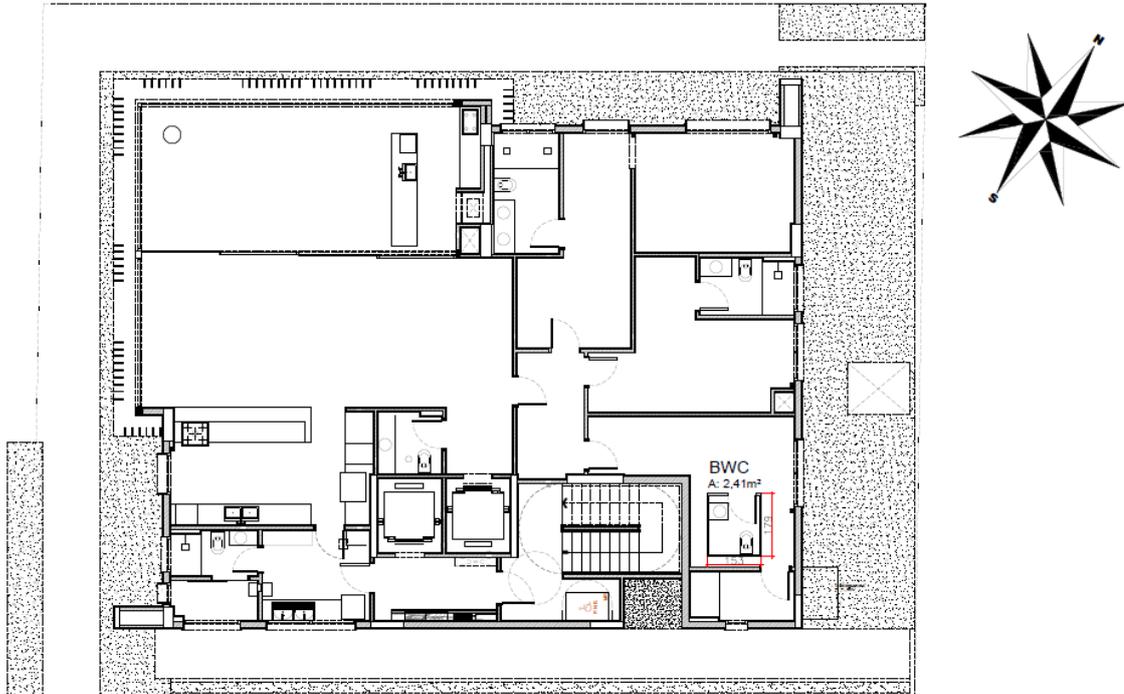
Canteiro de obras – obra 1, Térreo.
